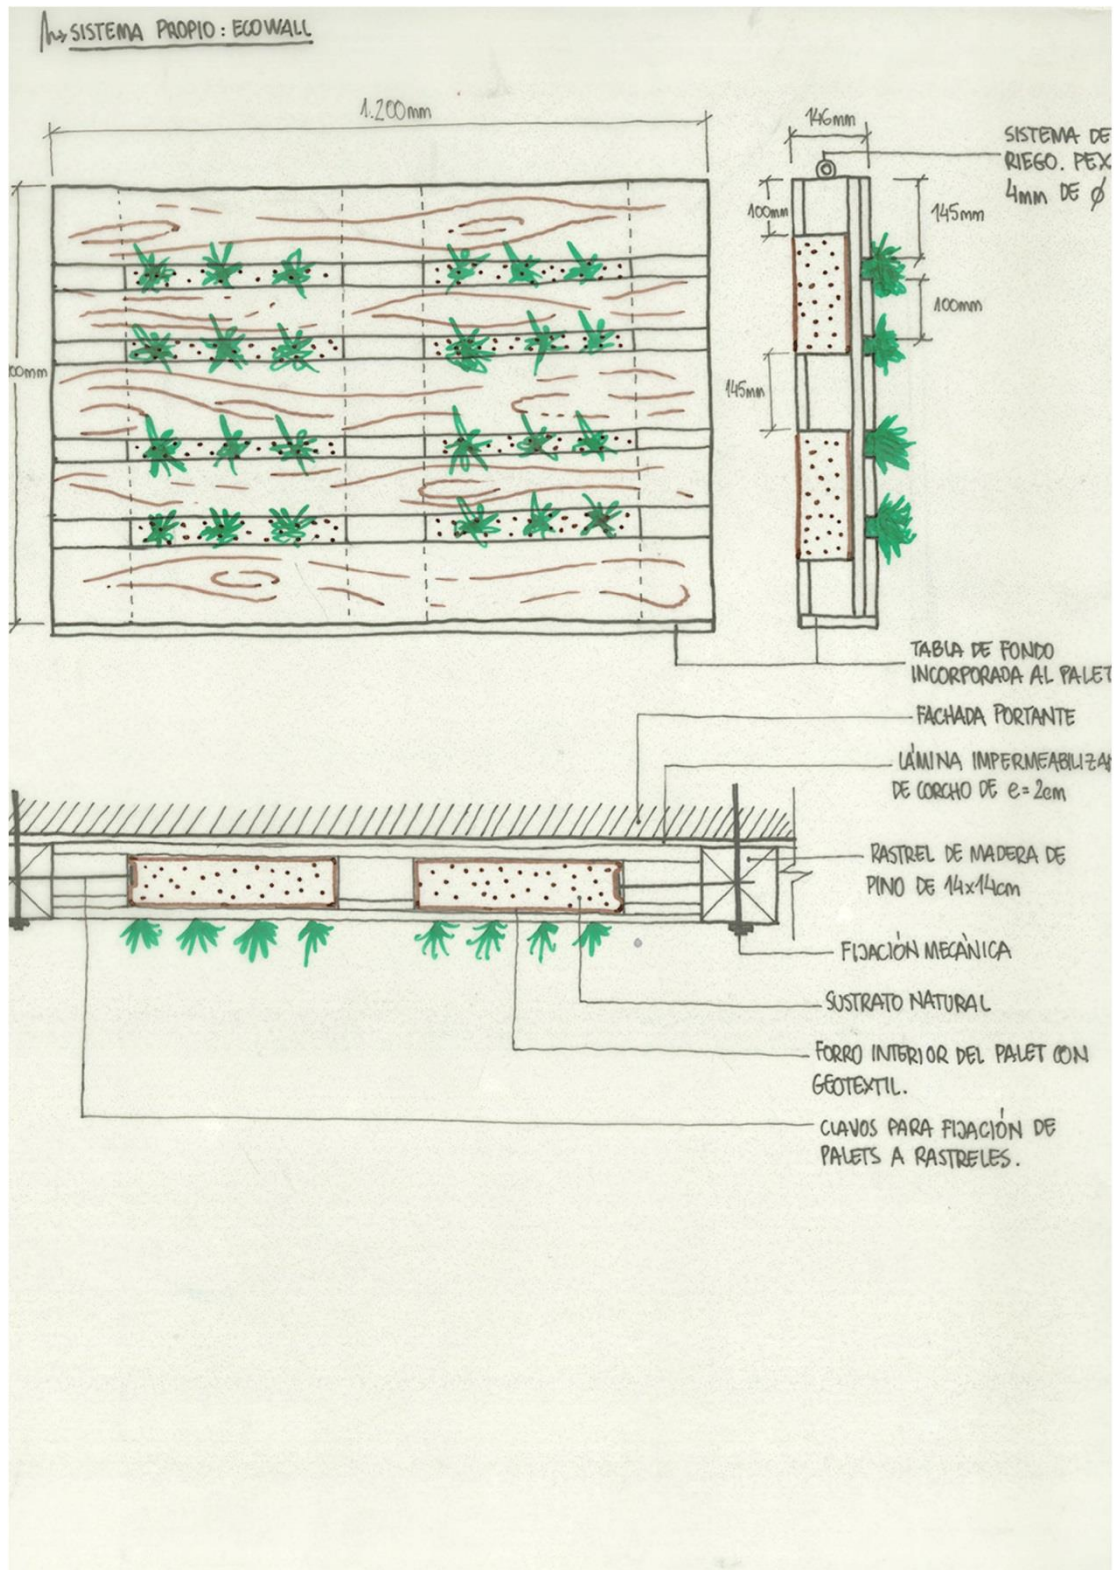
Detalle de elaboración propia del sistema propuesto, ECOWALL.
